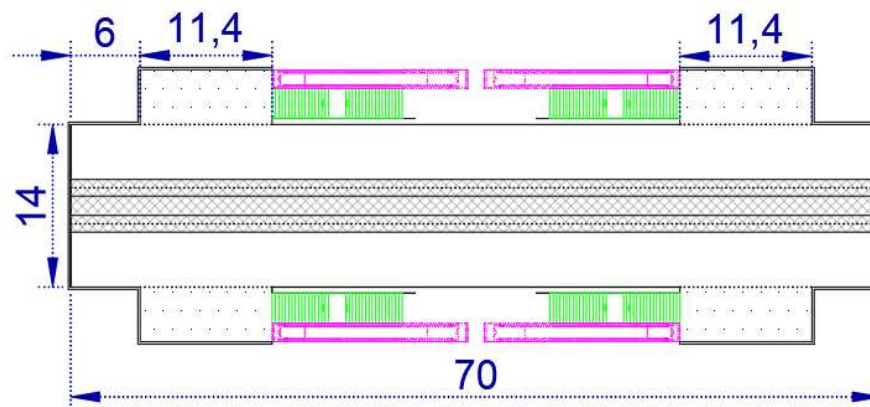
Planta da plataforma da estação de Salgueiros (dimensões em metros)
